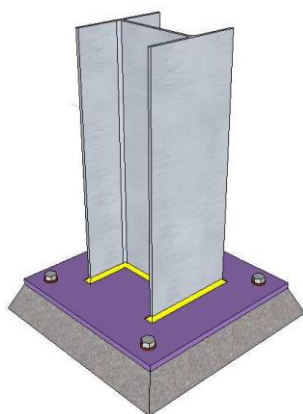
Ligação entre pilar metálico e sapata de betão armado com recurso a chapa de base e chumbadores metálicos [41].
